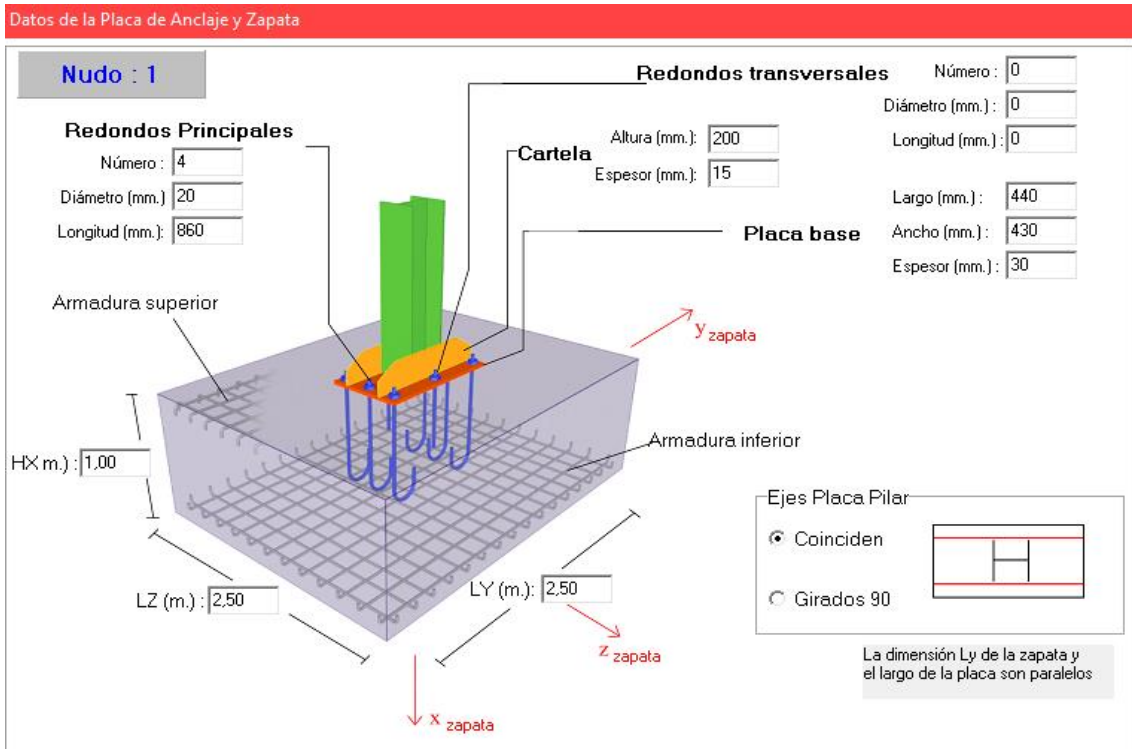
Detalle zapata tipo 1 (Nudo 1). Fuente: Metalpla XE 64
